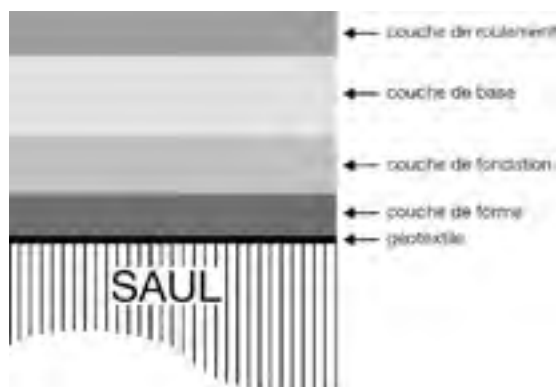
Coupe d'une SAUL avec chaussée perméable (Source : LCPC, Certu et Agences de l'Eau, (1998). Les structures alvéolaires en assainissement pluvial)
